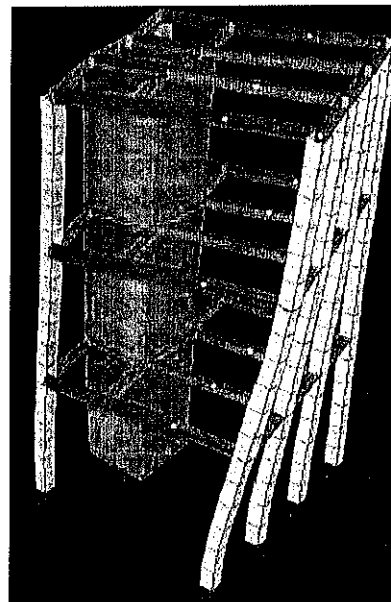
Torsión en estructuras por la excentricidad de elementos rígidos (CENAPRED, 2016).
